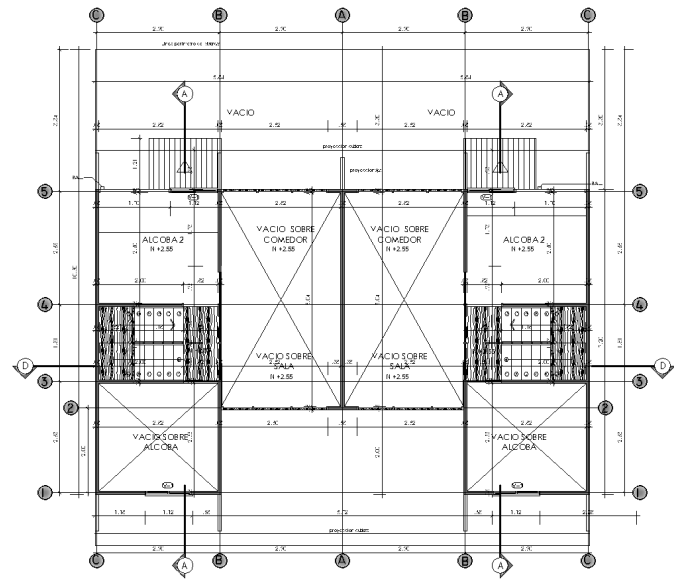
planta arquitectónica piso 2 (muros prefabricados-CC).
